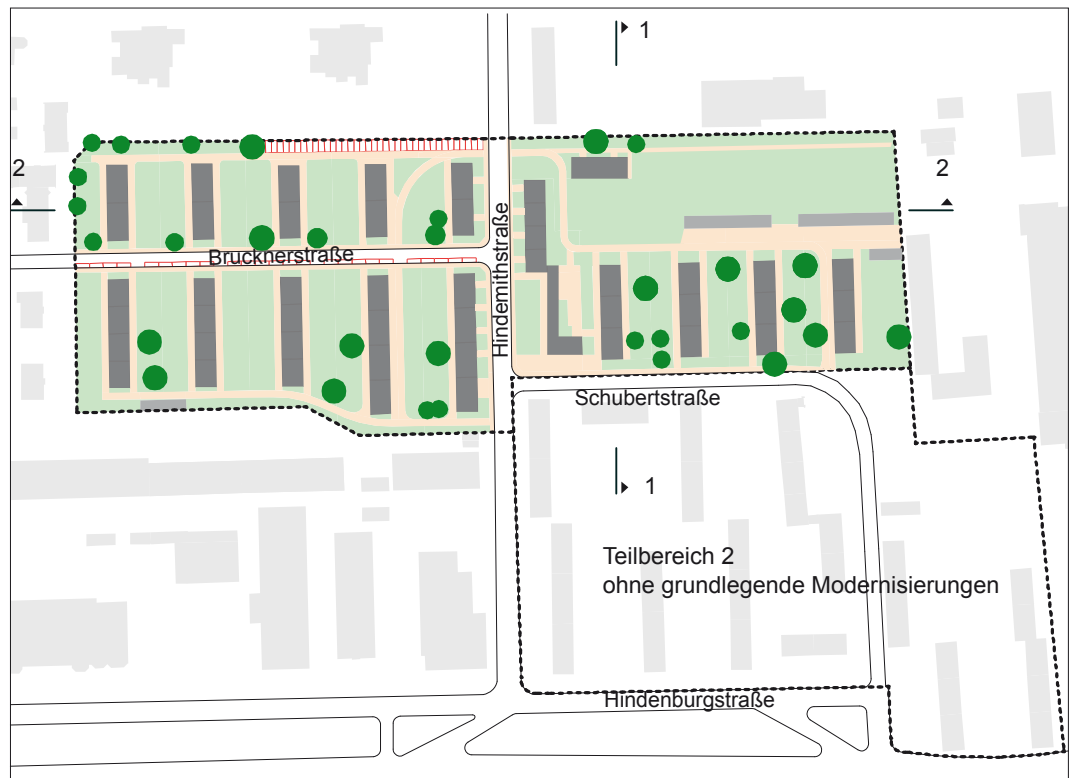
Lageplan Ingolstadt, Altbestand mit Flächenaufteilung
